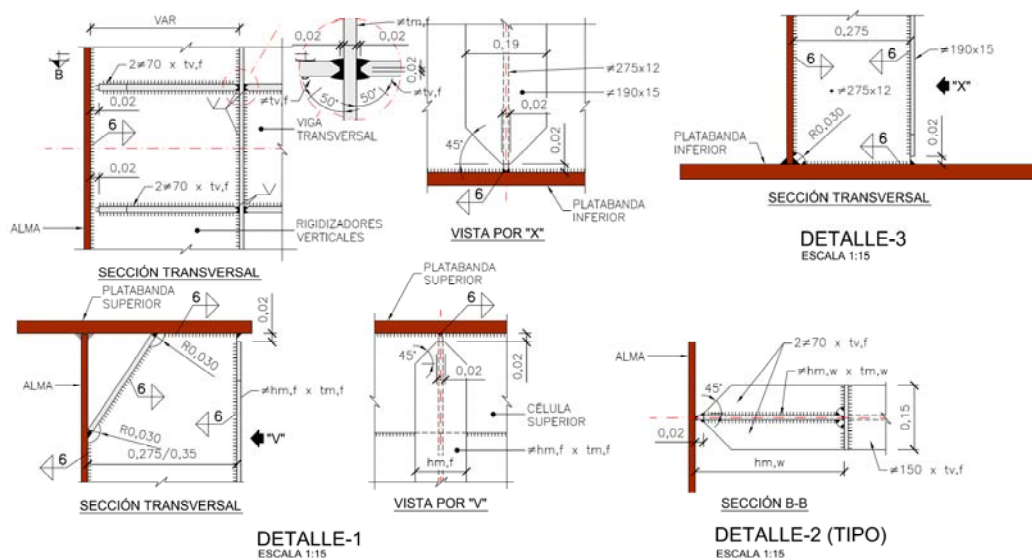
, 13b, 13c y 13d. Diafragmas transversales y detalles de rigidizadores verticales de almas.
